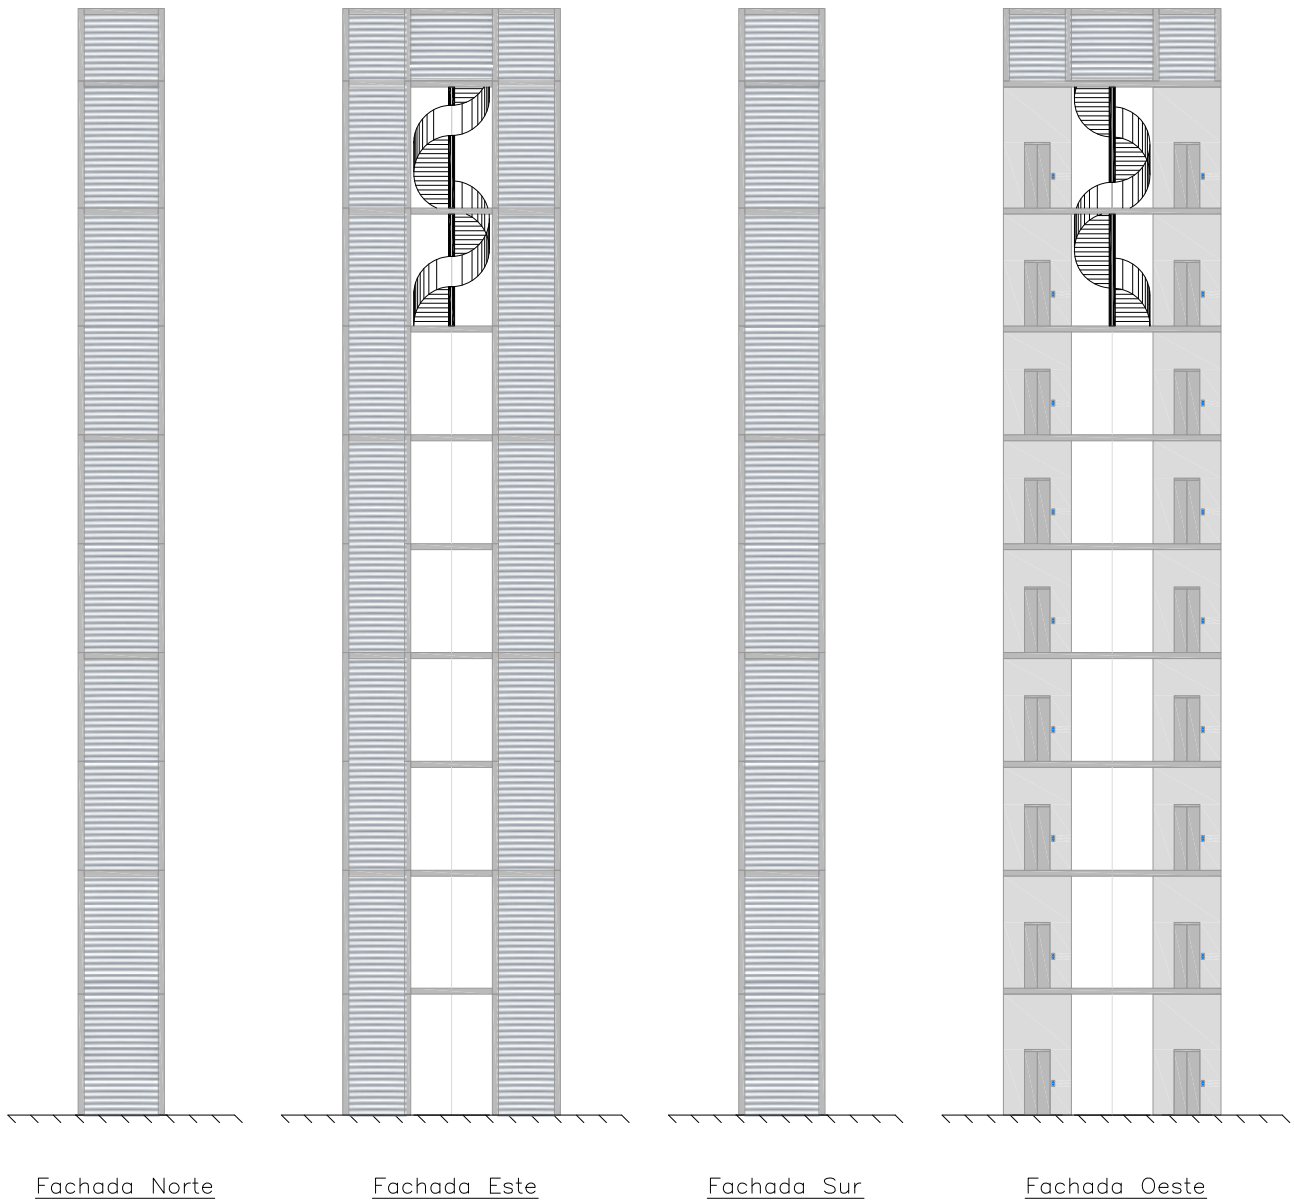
FACHADAS DEL CUBO DE ELEVADORES
